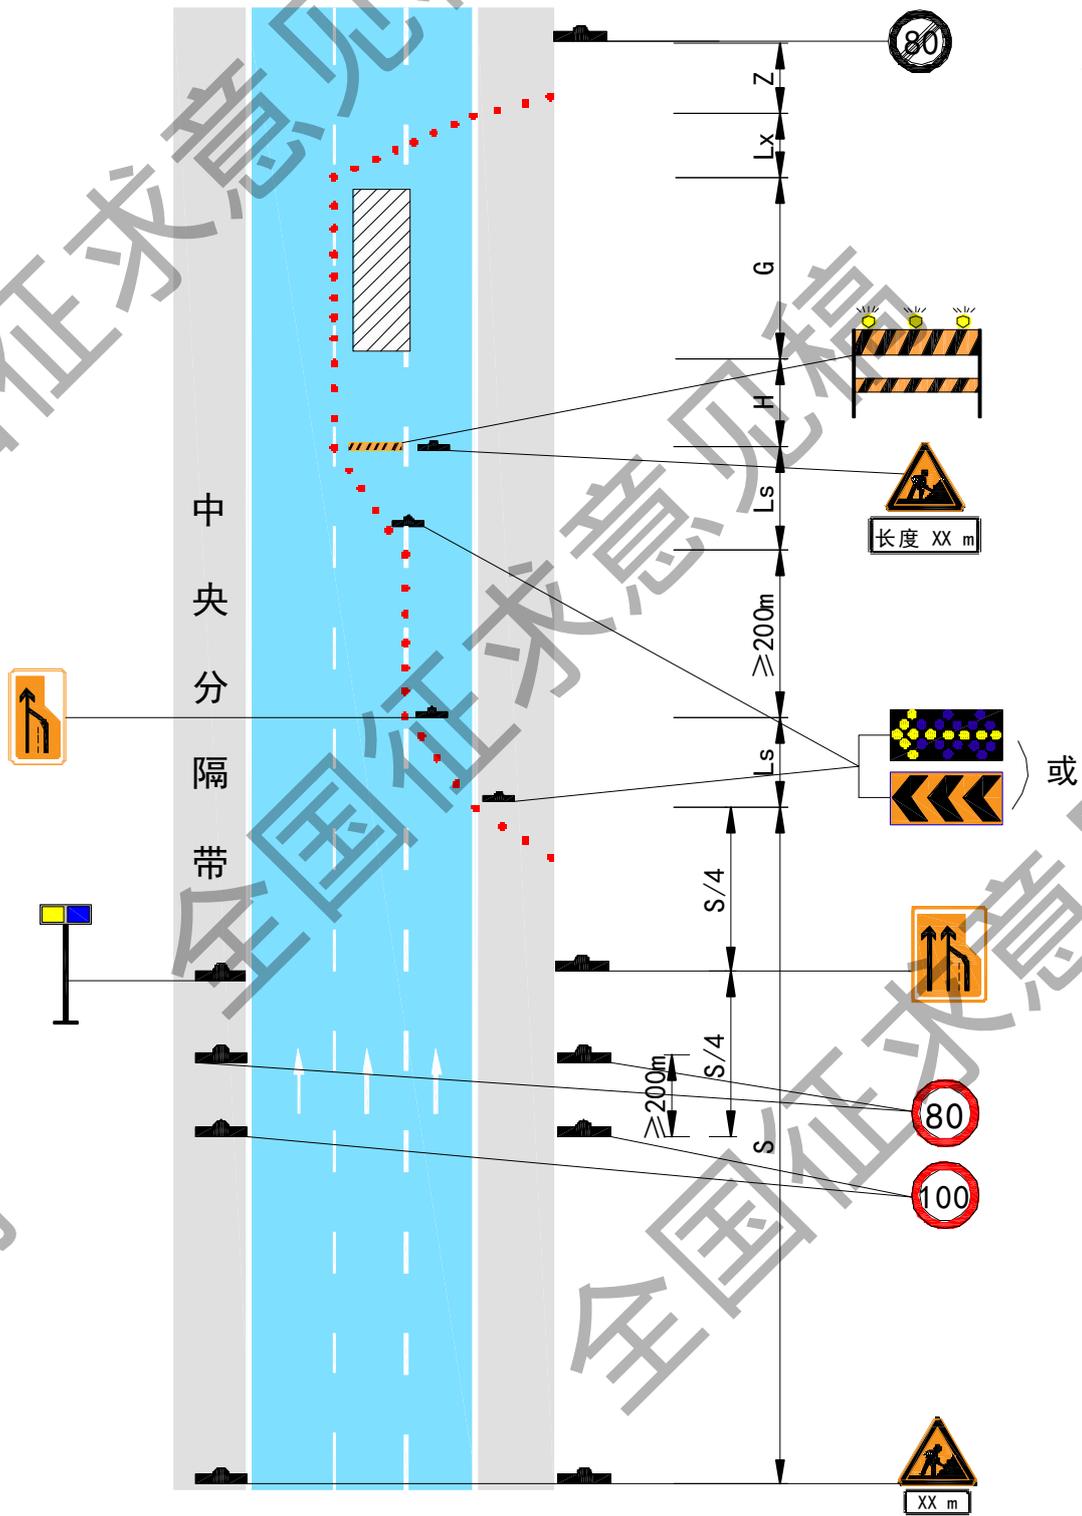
六车道高速公路及一级公路封闭外侧车道养护作业
